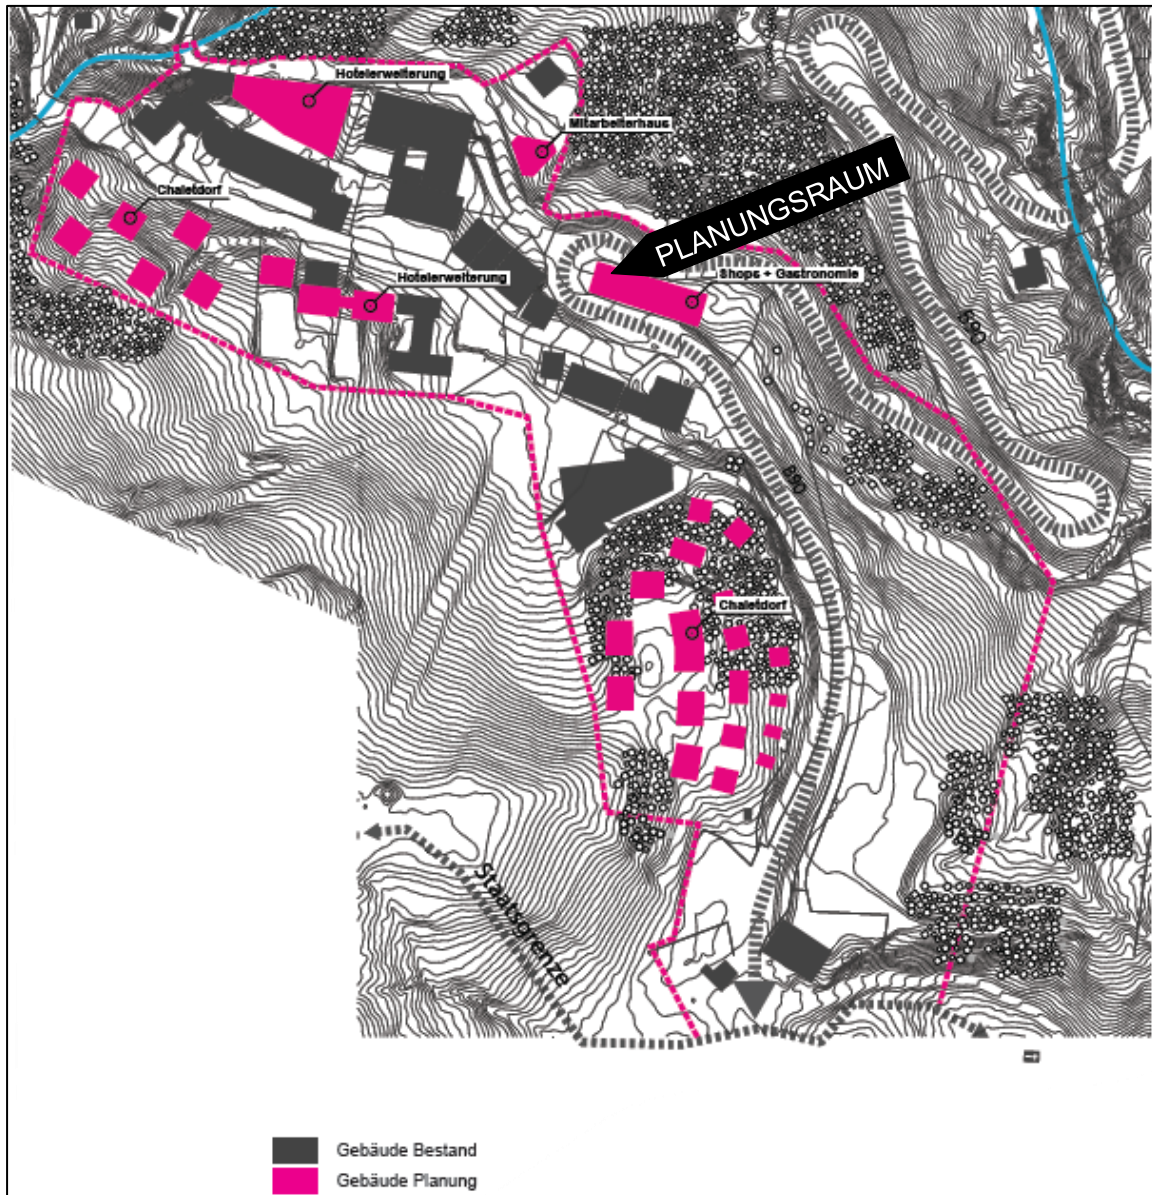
Ausschnitt Masterplan - Gebäude - Planung (Quelle: LWK)
